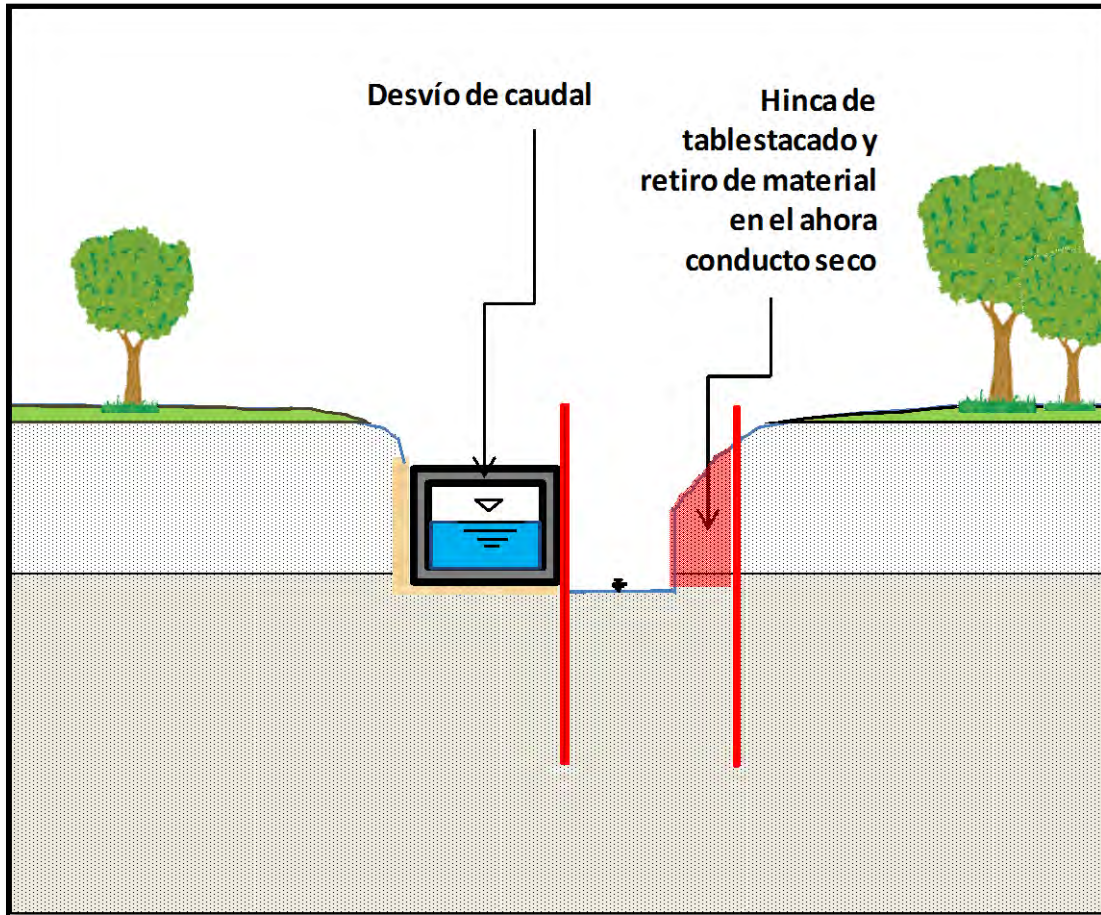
Una vez puesto en funcionamiento el cajón que ya está terminado longitudinalmente se coloca un tablestacado lateral opuesto al cajón construido para dejar este lado como el nuevo lado seco, para poder proseguir con los trabajos de la construcción del cajón, para alojar el caudal del río en ambos cajones.
